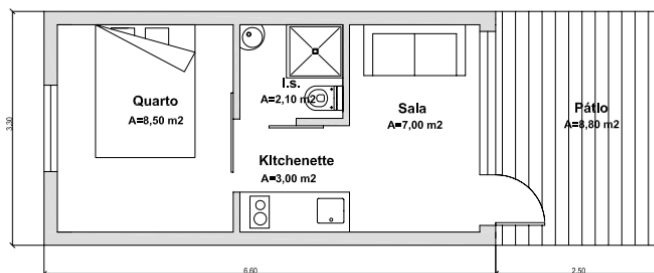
Planta *Treehouse Spot* Outão, s/escala, JULAR.
